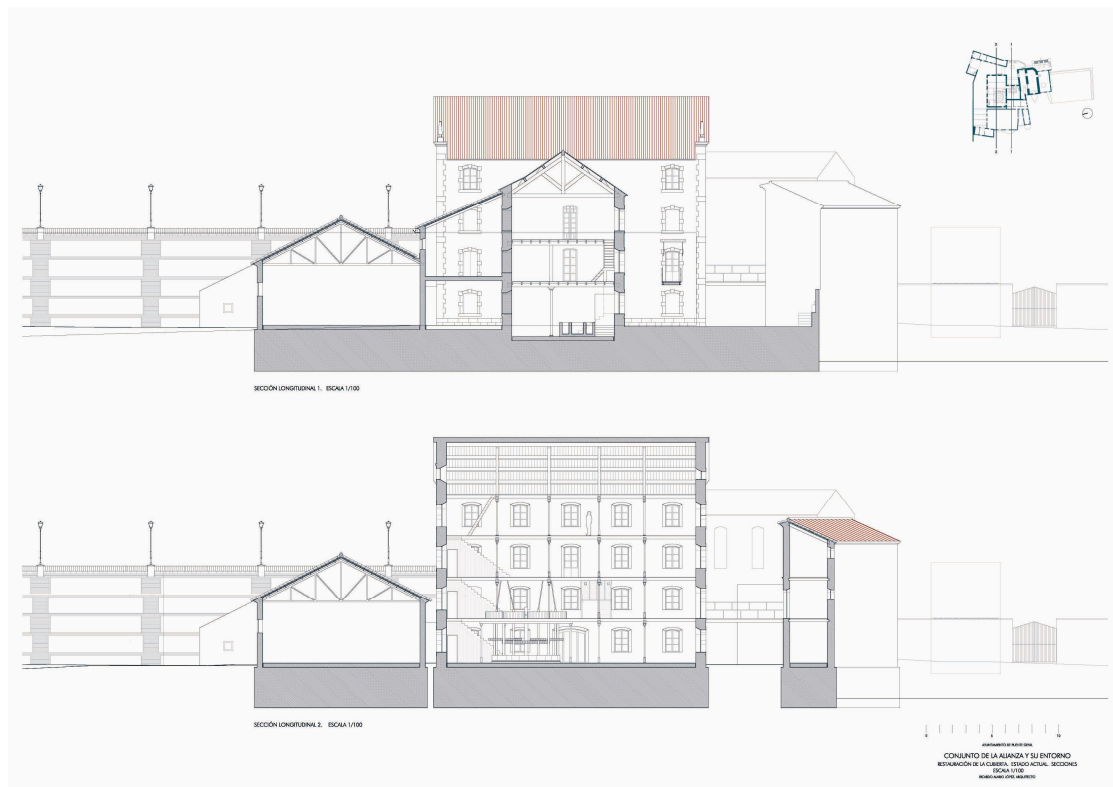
Sección longitudinal realizada para la restauración de la cubierta. Escala 1/100. Fuente: Ricardo Alario López.
